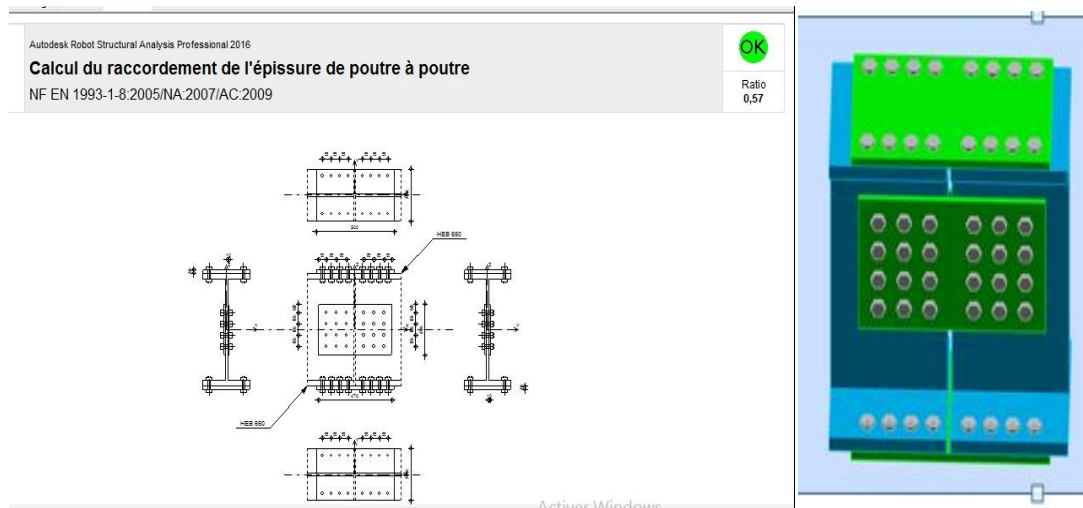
Assemblage de continuité (poteau-poteau).
